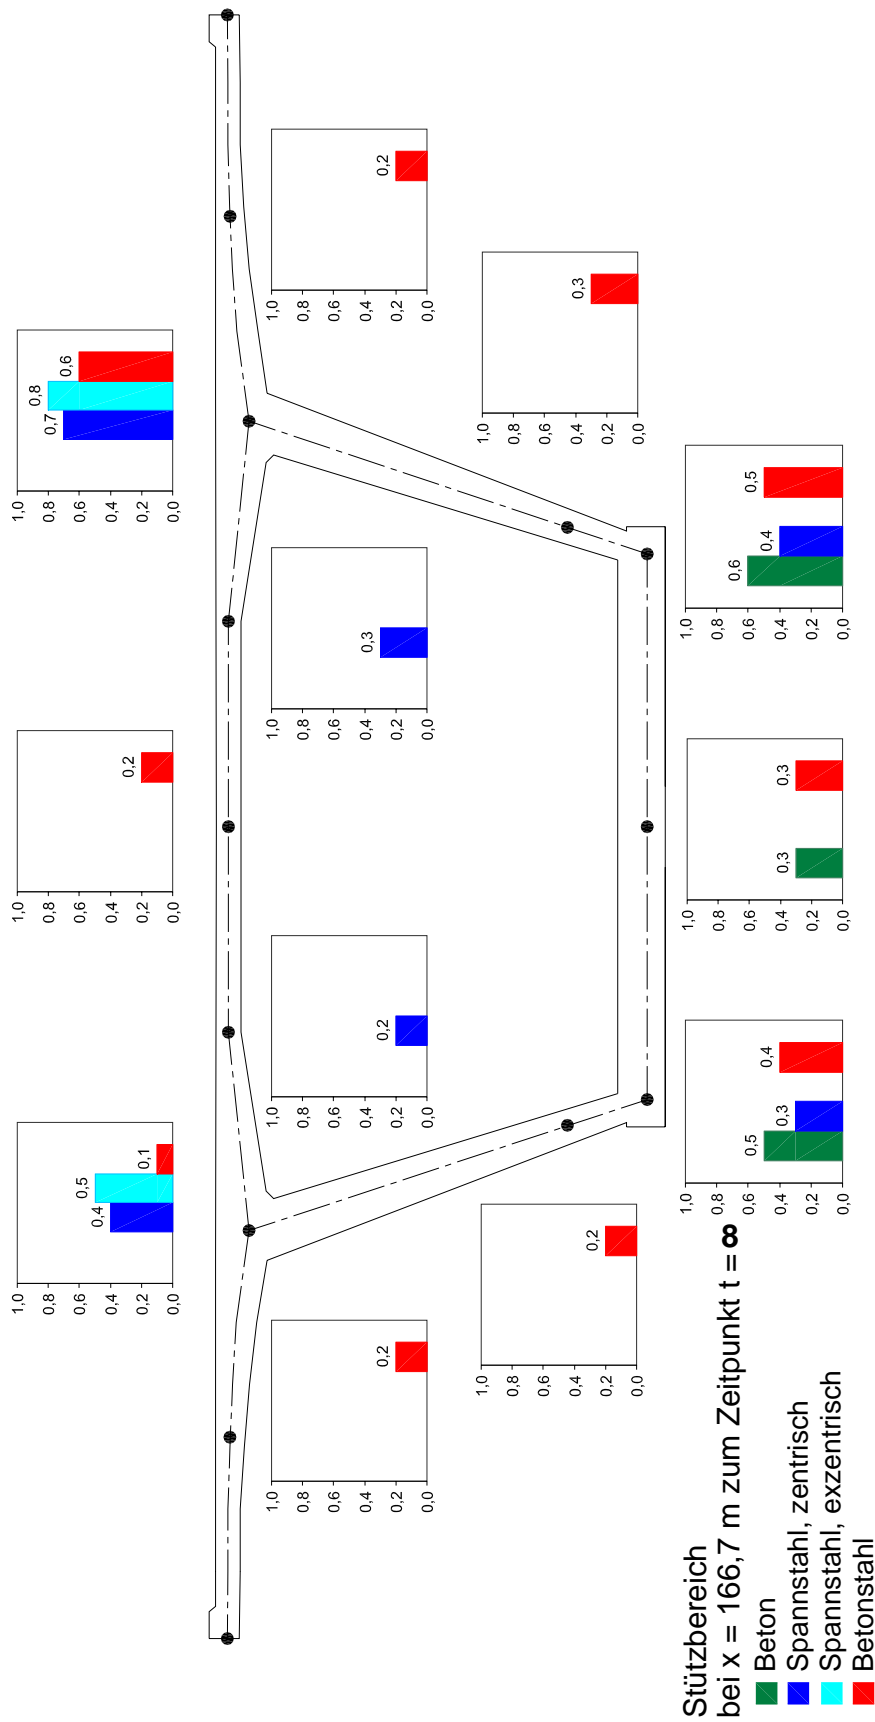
Ausnutzungsgrade des Betons δ_c , Spannstahls δ_p und Betonstahls δ_s
